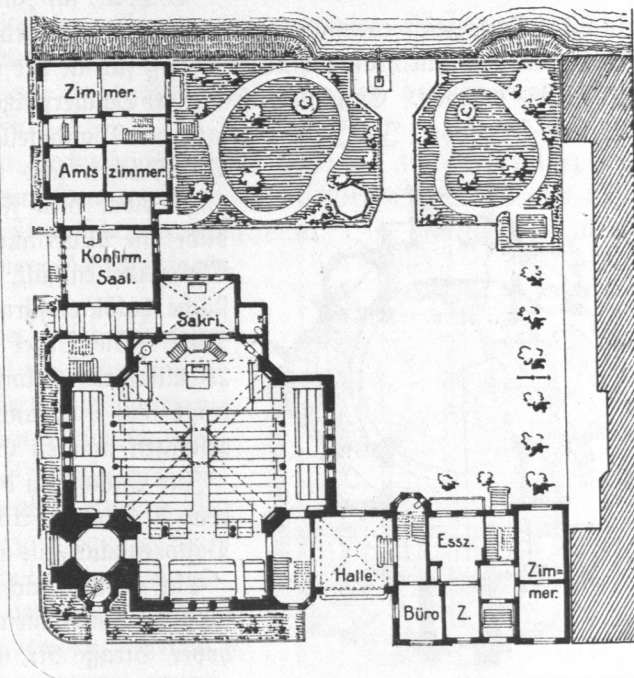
St.-Annen-Kirche, Hammerbrook, Grundriß.
